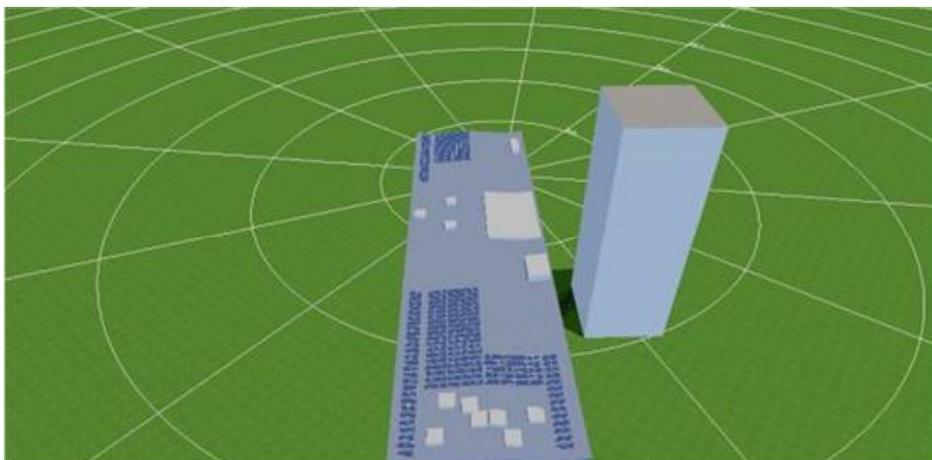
esquema de techo con posible solución, alternativa 1. Vista este.
